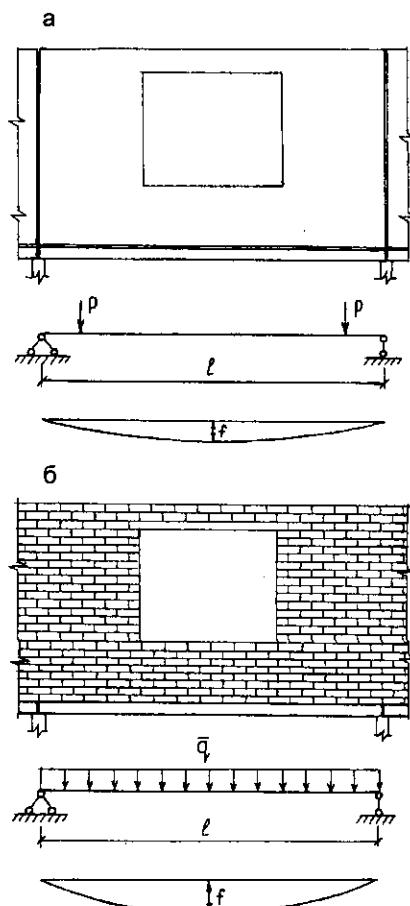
Схемы передачи нагрузок на перекрытие от навесных стен
